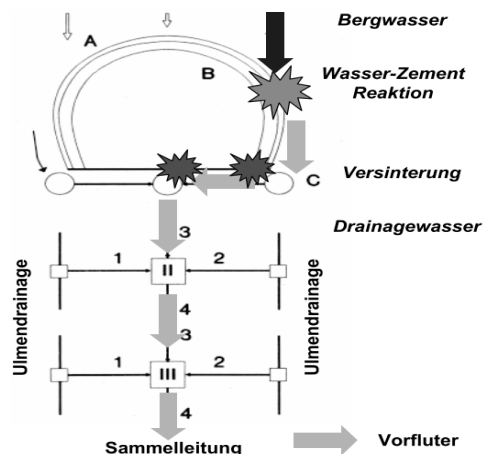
Schematischer Querschnitt und Grundriss des Drainagesystems von Tunnelbauten.
